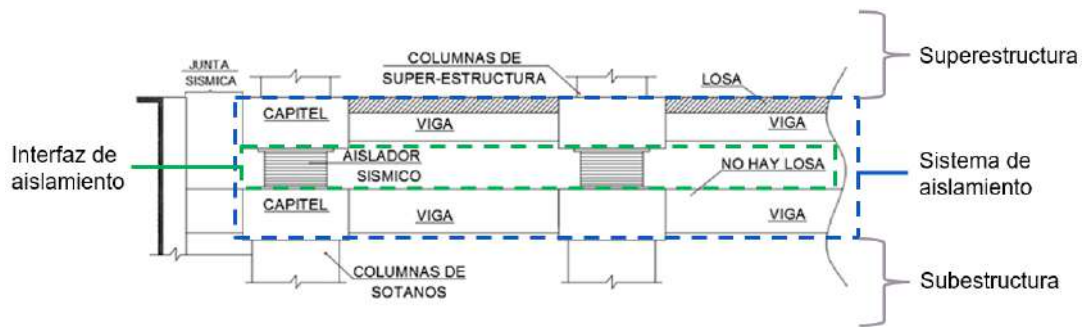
Esquema del sistema de aislamiento de edificación con sótanos.
